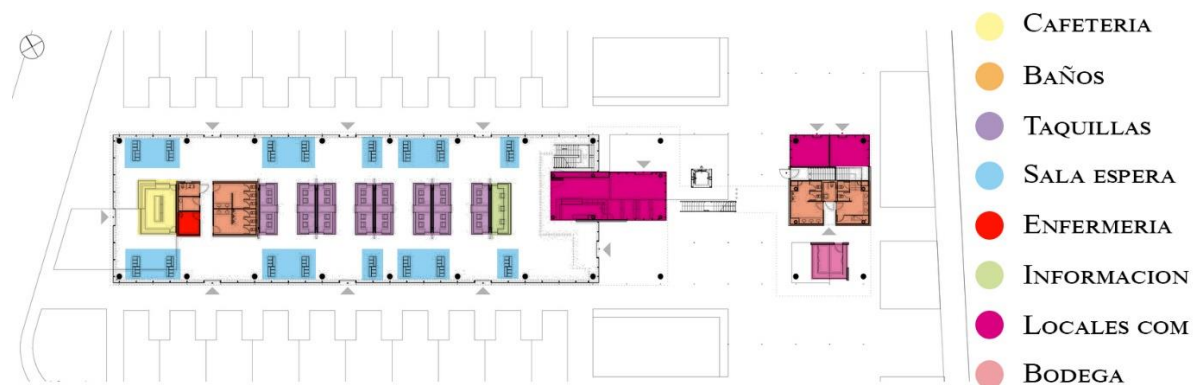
Primera planta. Estación de Autobuses Lüleburgaz.
